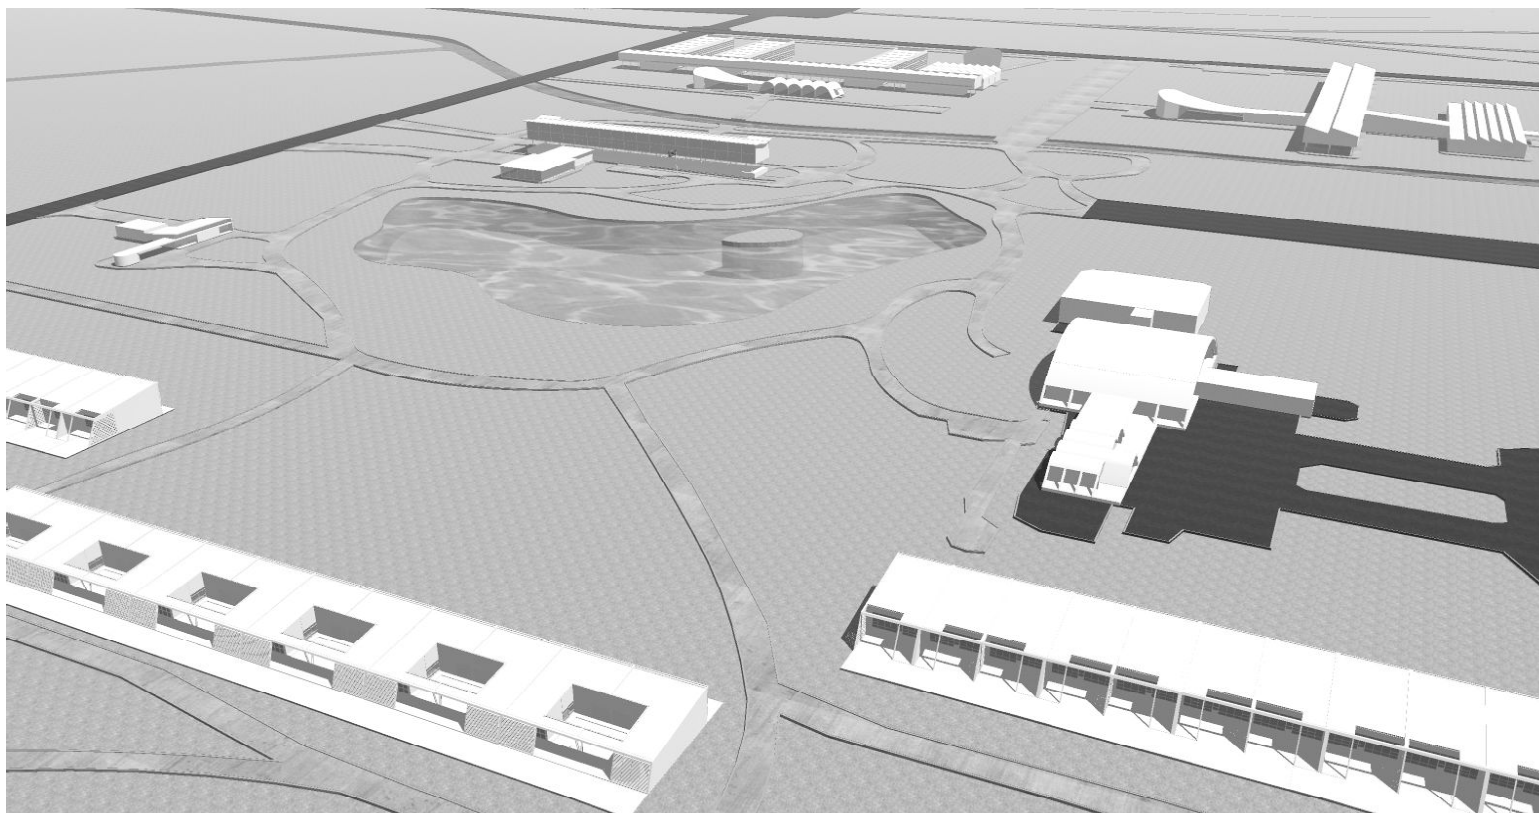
Zona Residencial no Primeiro Plano, Blocos de casas geminadas abaixo, Rancho e Reembolsável à esquerda e ao fundo a Zona Escolar. Fonte: www.saomodernasjose.com.br, acessado em dezembro de 2018.
